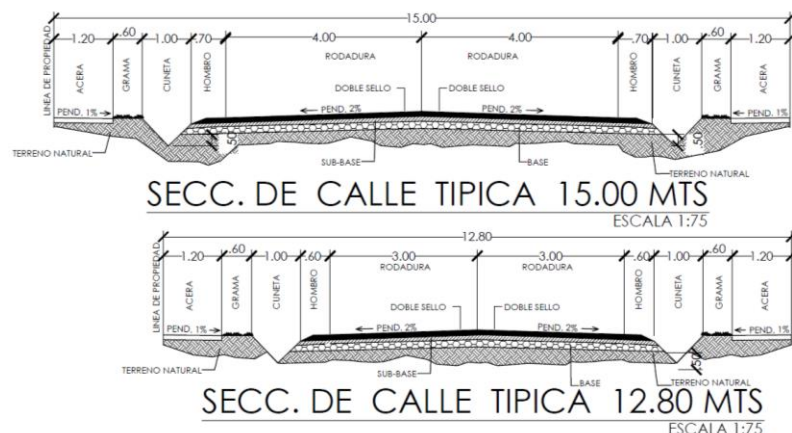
Detalle de las secciones de las calles, aceras y cuentas. Fuente: Anteproyecto
